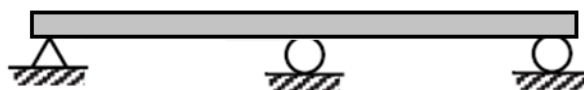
Viga articulada y doblemente apoyada (Flores, 2018).
